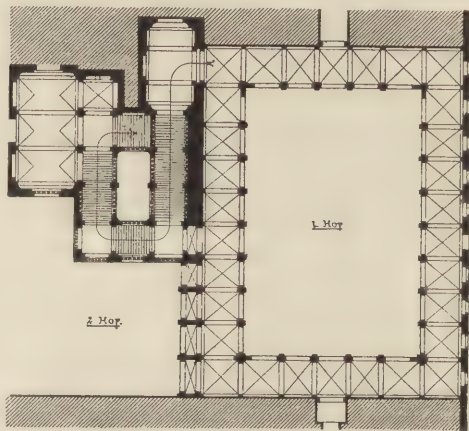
Palazzo Altieri zu Rom. Grundriss des Hofes und der Treppe.
